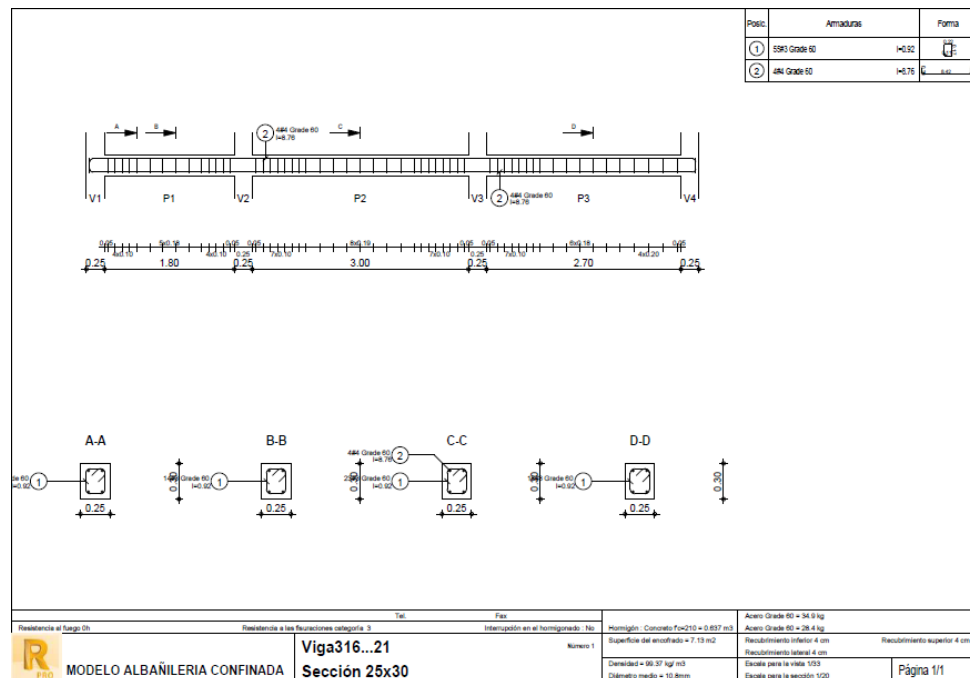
Plano de ejecución por defecto de la viga en Robot.
